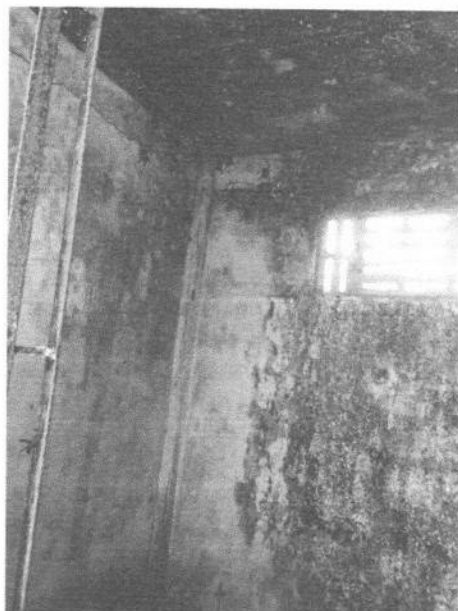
Fissura em viga, com destaque as manchas de infiltração na laje.
